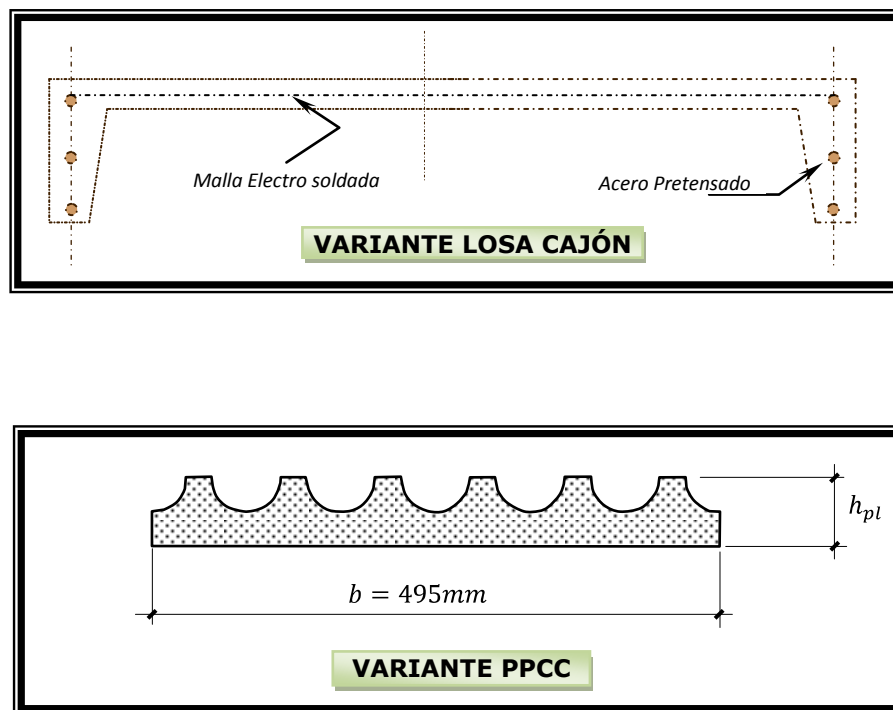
Tipología de la sección transversal de las variantes de losa que se seleccionan.
